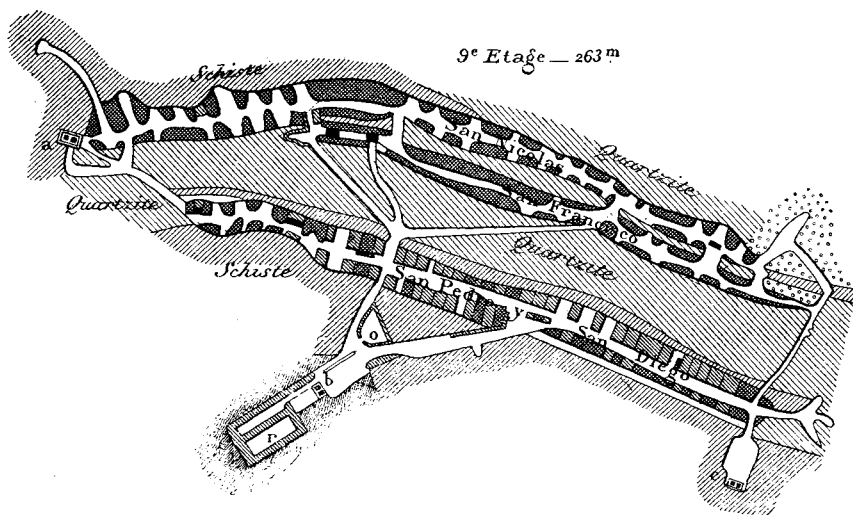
Plan de la mine d'Almaden au 9<sup>e</sup> étage (263 mètres).
